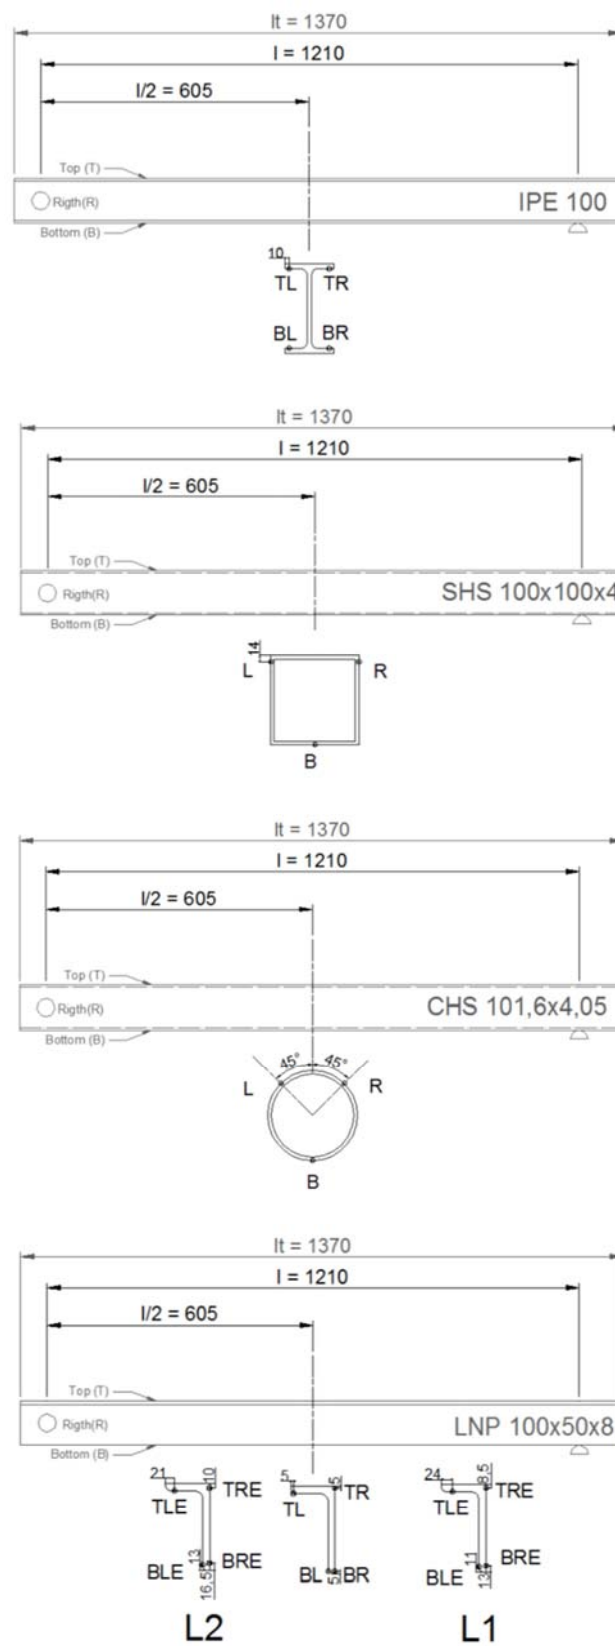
Localização dos extensómetros nos elementos para as várias secções transversais.
